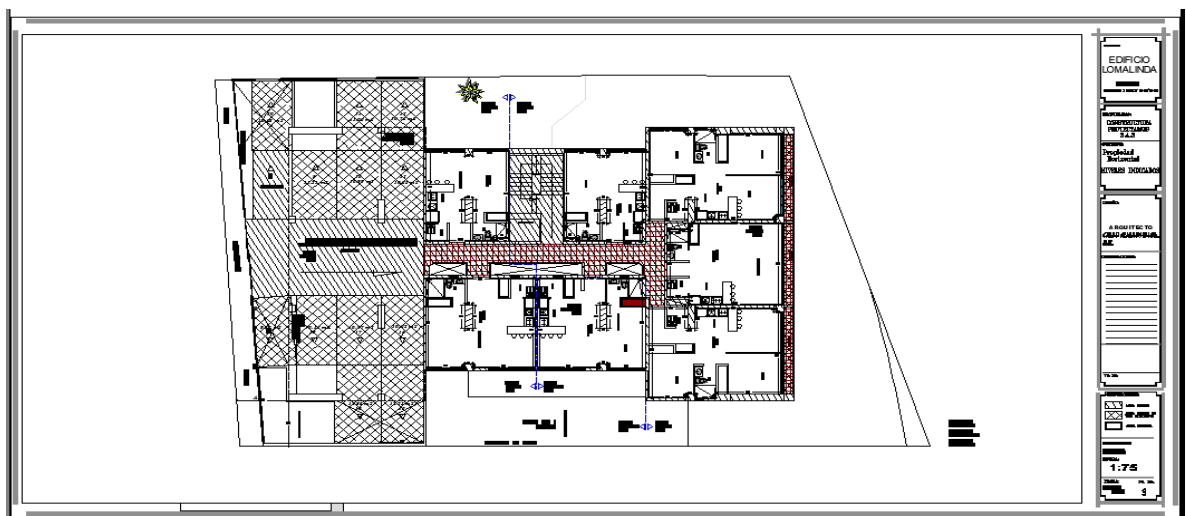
PLANO PROPIEDAD HORIZONTAL – PLANO 2.
